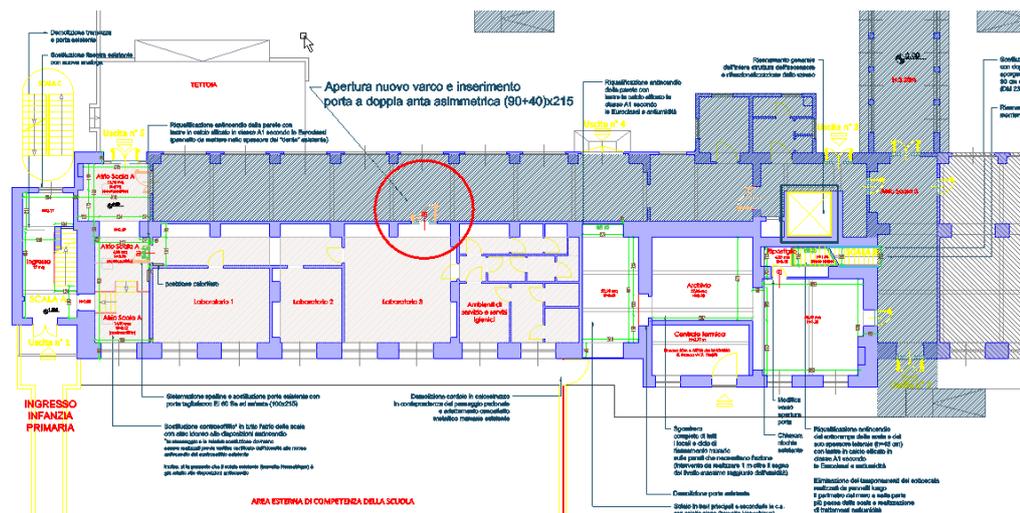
Stralcio pianta piano terra con individuazione dell'apertura da realizzare (cerchiata in rosso)
